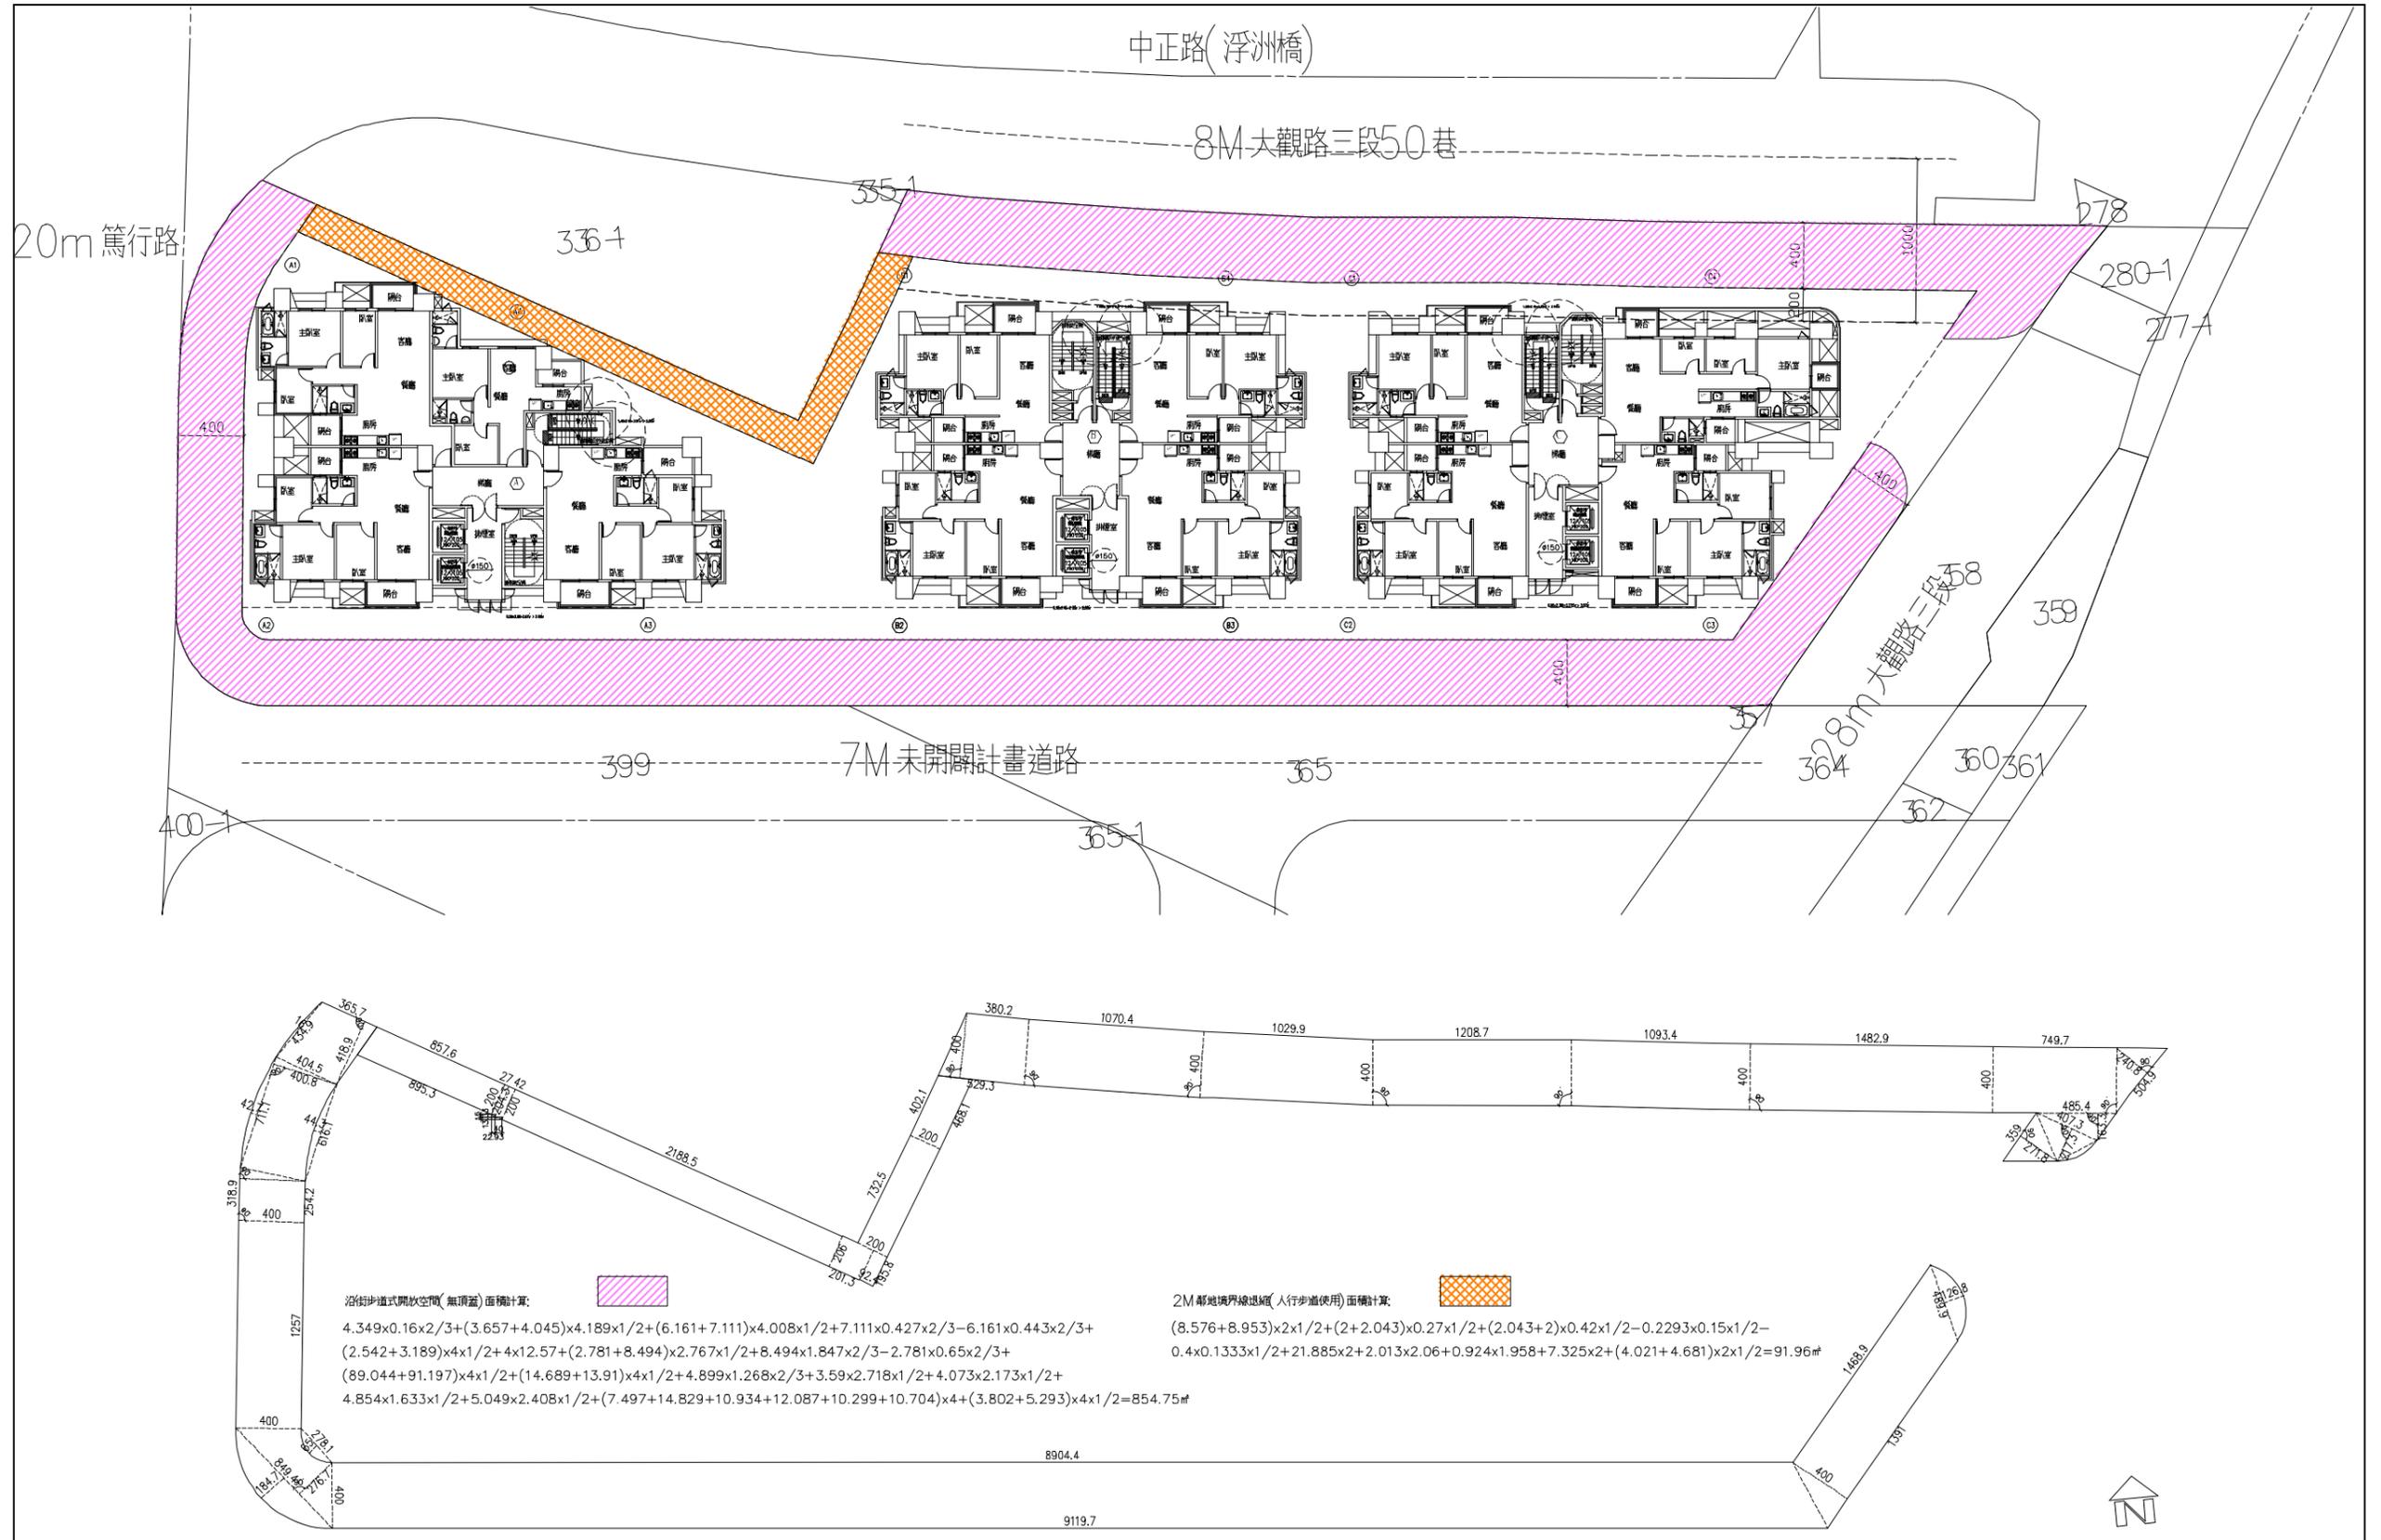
開放空間套繪標準層平面示意圖(S: 1/400)
